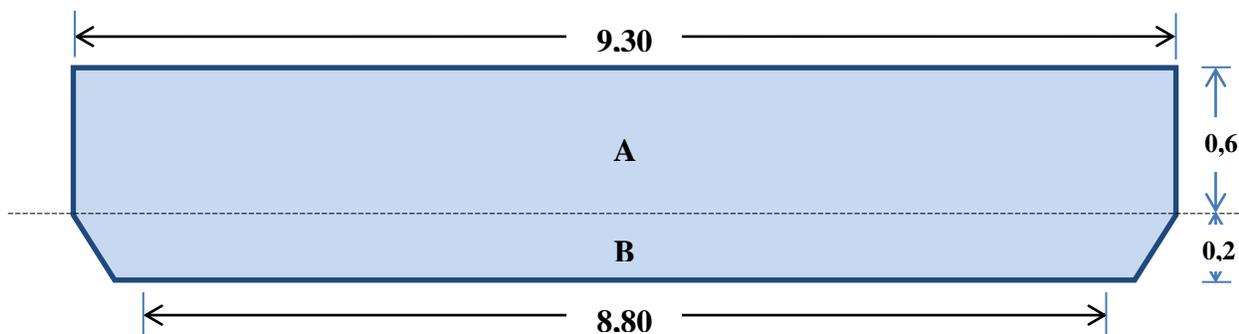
Sección de viga de arriostramiento de Recuperador
